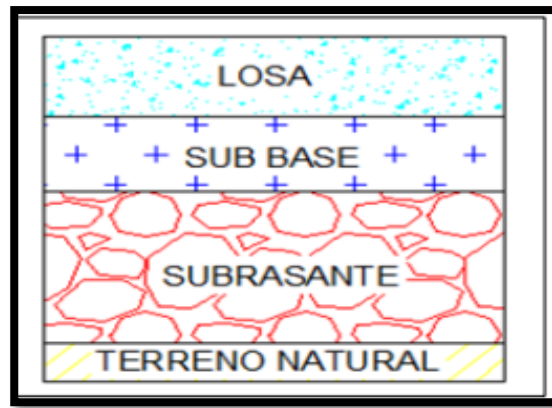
Estructura de un pavimento flexible. ( Mora y Mendoza, 2016)
